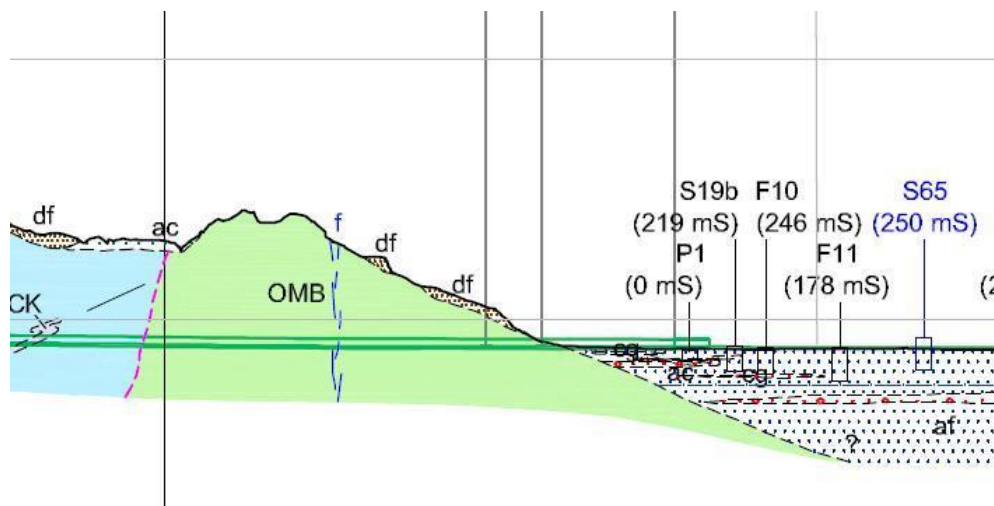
Stralcio del profilo geologico in asse Tunnel di Base nella zona dell'imbocco est del Tunnel di Base
